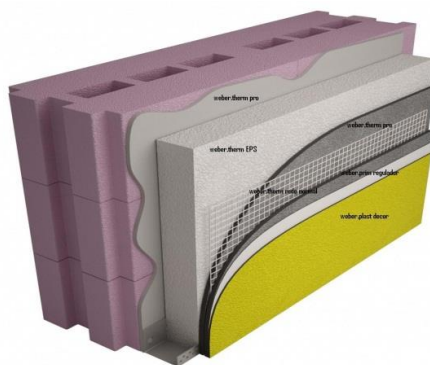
Vista geral da constituição de sistemas ETICS, aplicado sobre parede base
